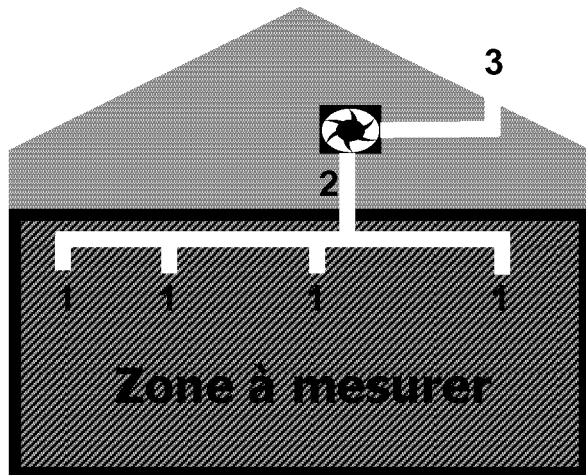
Position du scellement des conduits de ventilation (pour un ventilateur hors du volume protégé) : au niveau des bouches individuelles (1), entre le ventilateur et l'enveloppe de la zone à mesurer (2), ou au niveau des prises d'air et de rejet (3).
